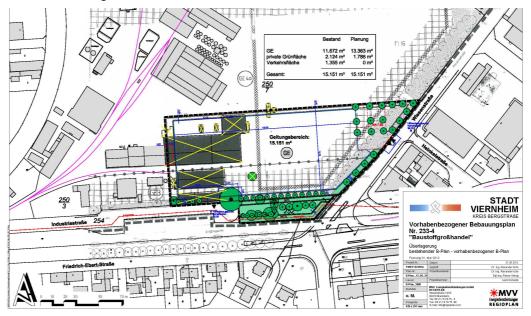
Überlage des Geltungsbereichs mit dem Bebauungsplan 233
